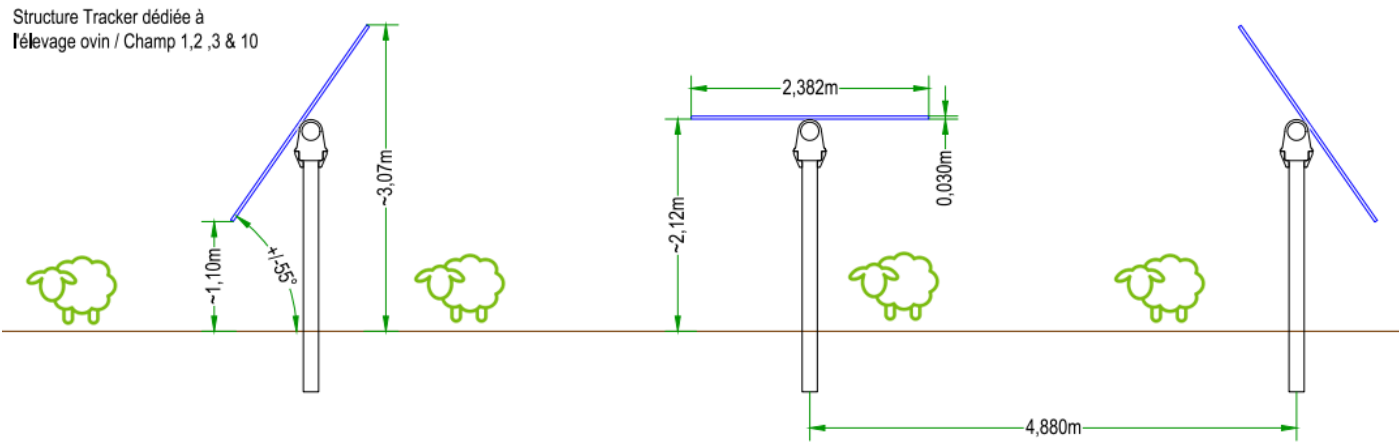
Structures porteuses - centrale de type "tracker" - Elevage ovin
